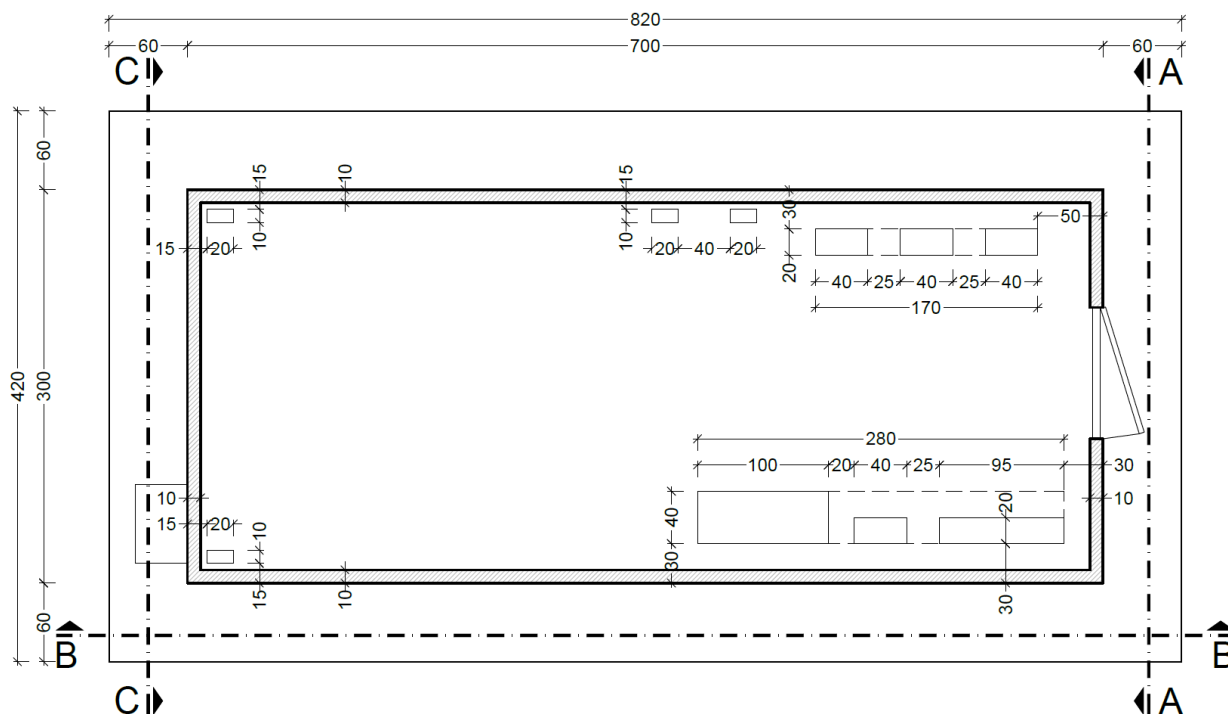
Pianta tipo basamento fondazione PPT con indicazione forometrie
